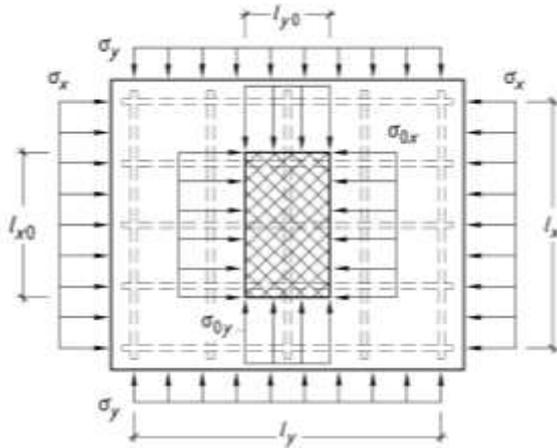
Расчетная схема для определения значения бокового давления при местном действии сжимающей нагрузки в пределах обоих слоев косвенно армированного двухслойного бетонного элемента
